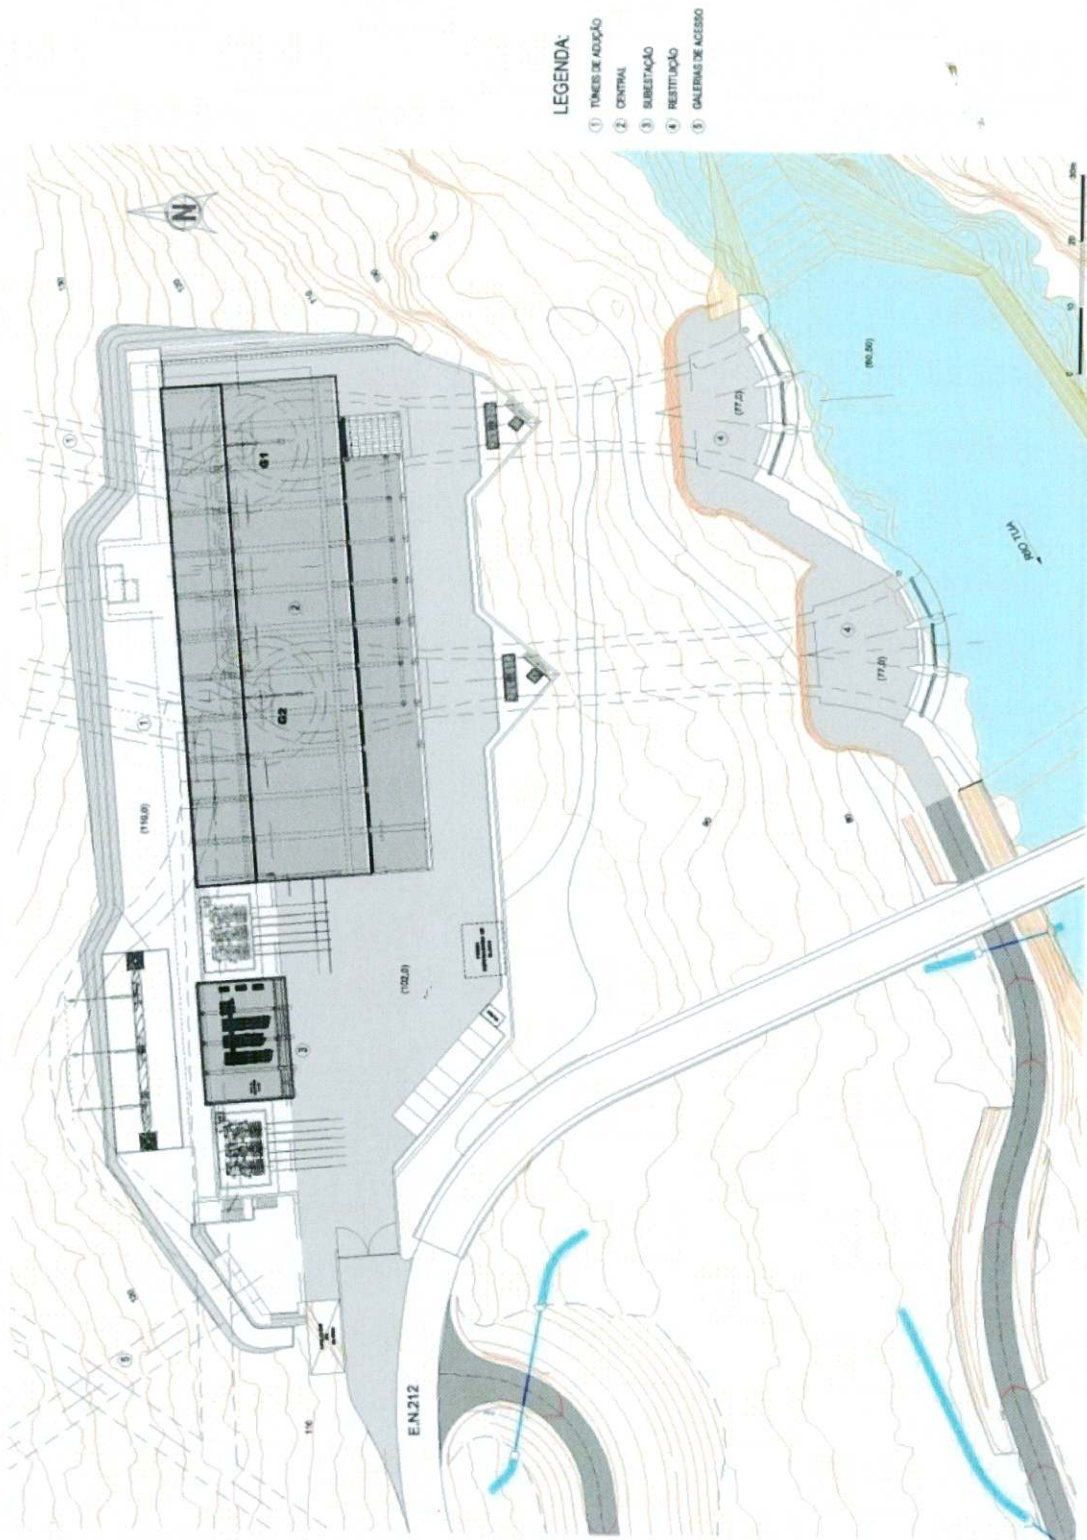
Planta da central e da subestação (Fonte EDP).
